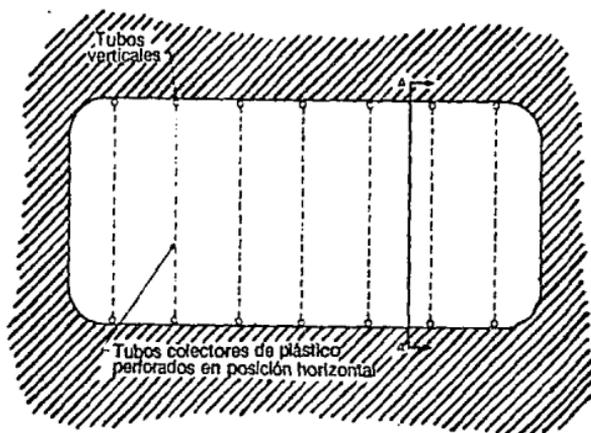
Vista de planta de un sistema de venteo de gas de confinamiento. Fuente: Wright, 1989
